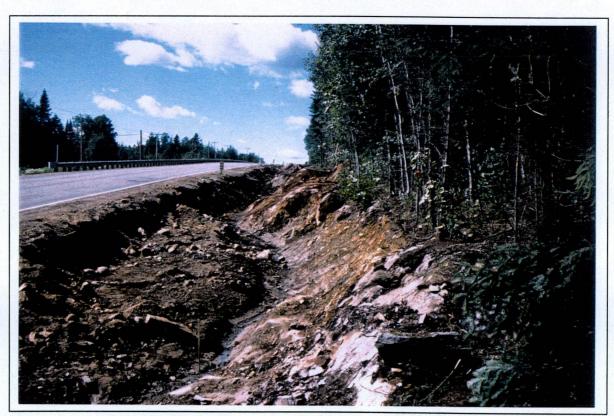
Projet 6571-8628, route 131, secteur 2, vers chaînage 10 + 400. (N)
